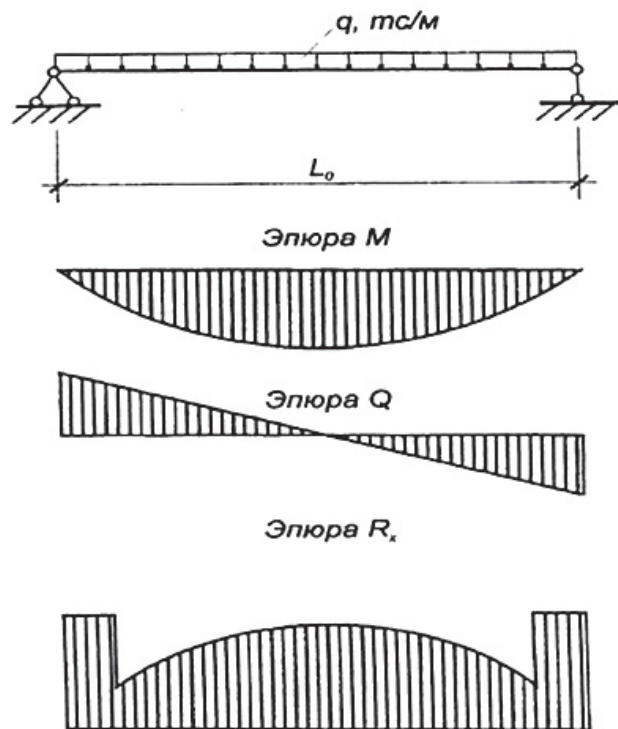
Расчётные и контрольные эпюры усилий для однопролётной железобетонной балки
